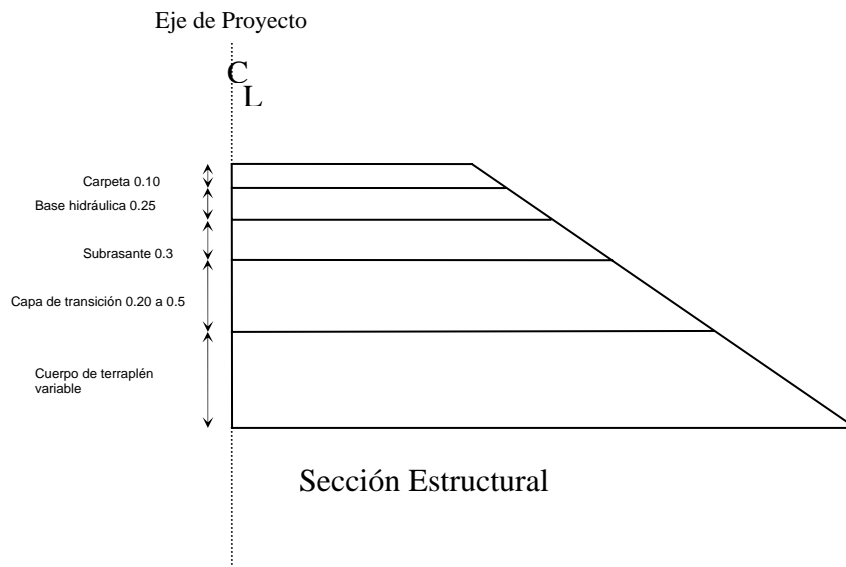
Esquema de la estructura del pavimento contemplada en este proyecto.
